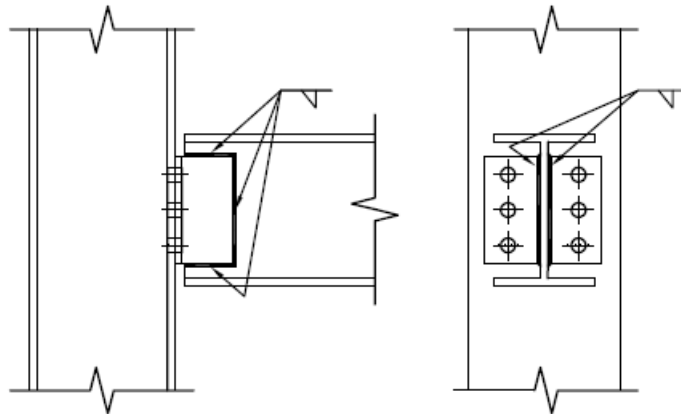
ligação flexível com duas cantoneiras soldadas na alma da viga
